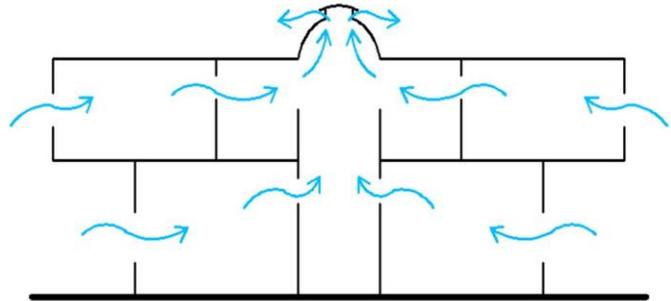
Sistema combinado de ventilación cruzada con chimenea de viento a aplicar en la propuesta.
